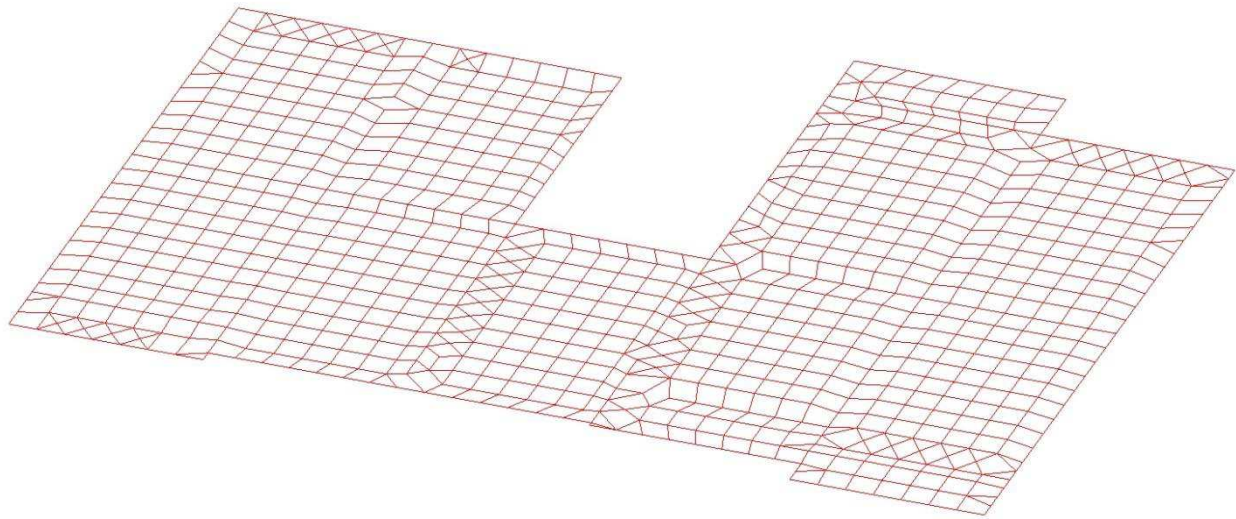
Расчетная схема плиты перекрытия в пространстве.
